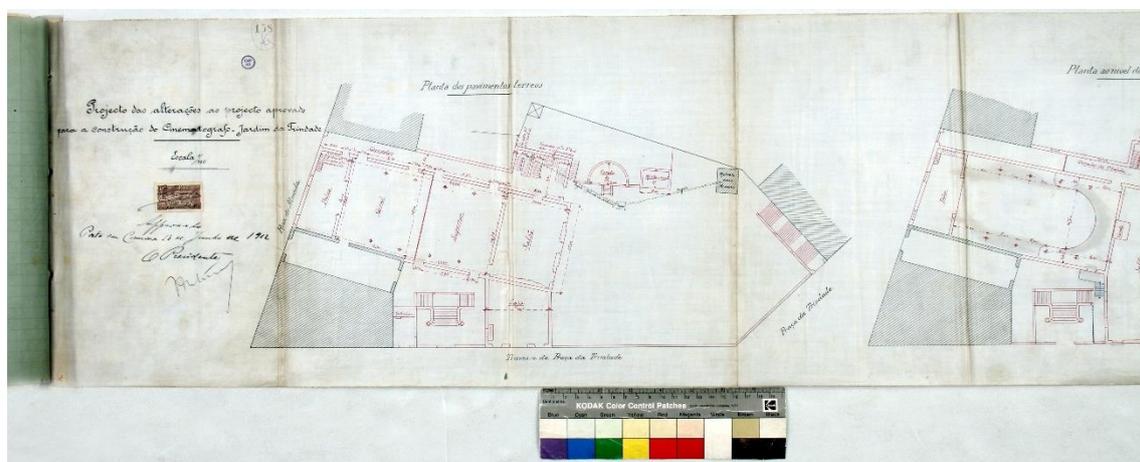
Planta do pavimento térreo do Cinematógrafo
